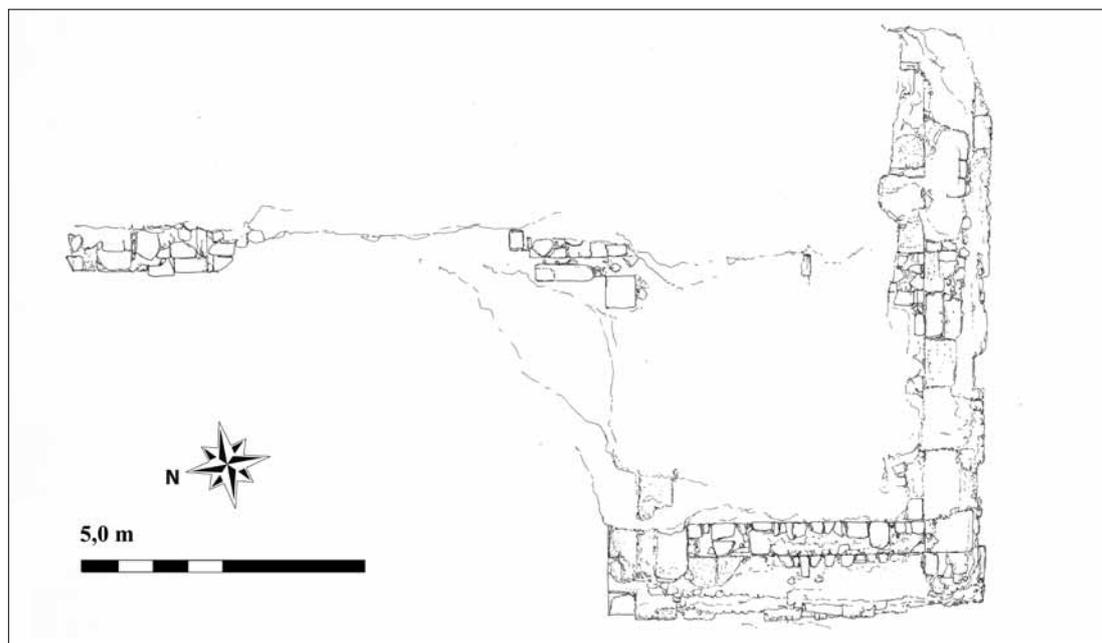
Torre 6.12, pianta (disegno C. Frigerio).
